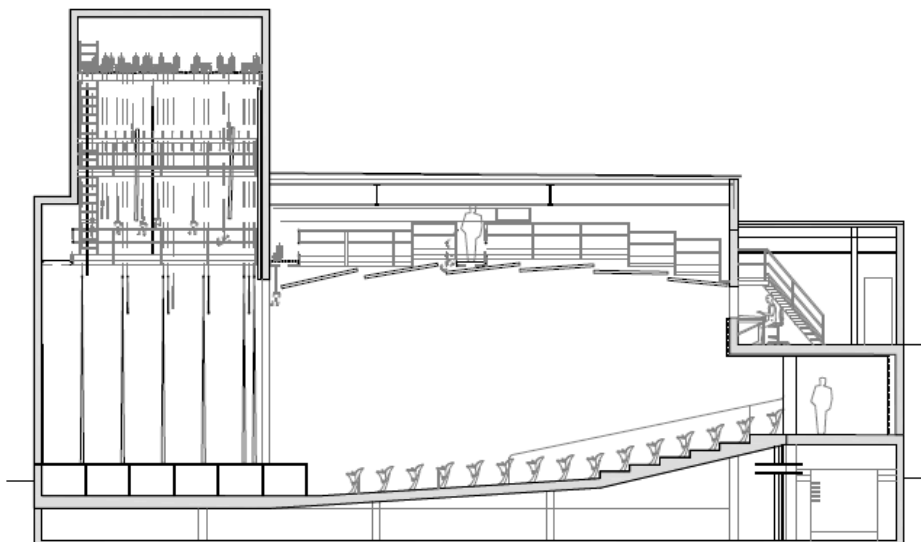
Sección (Planos fuente: Escala Arquitectos).
